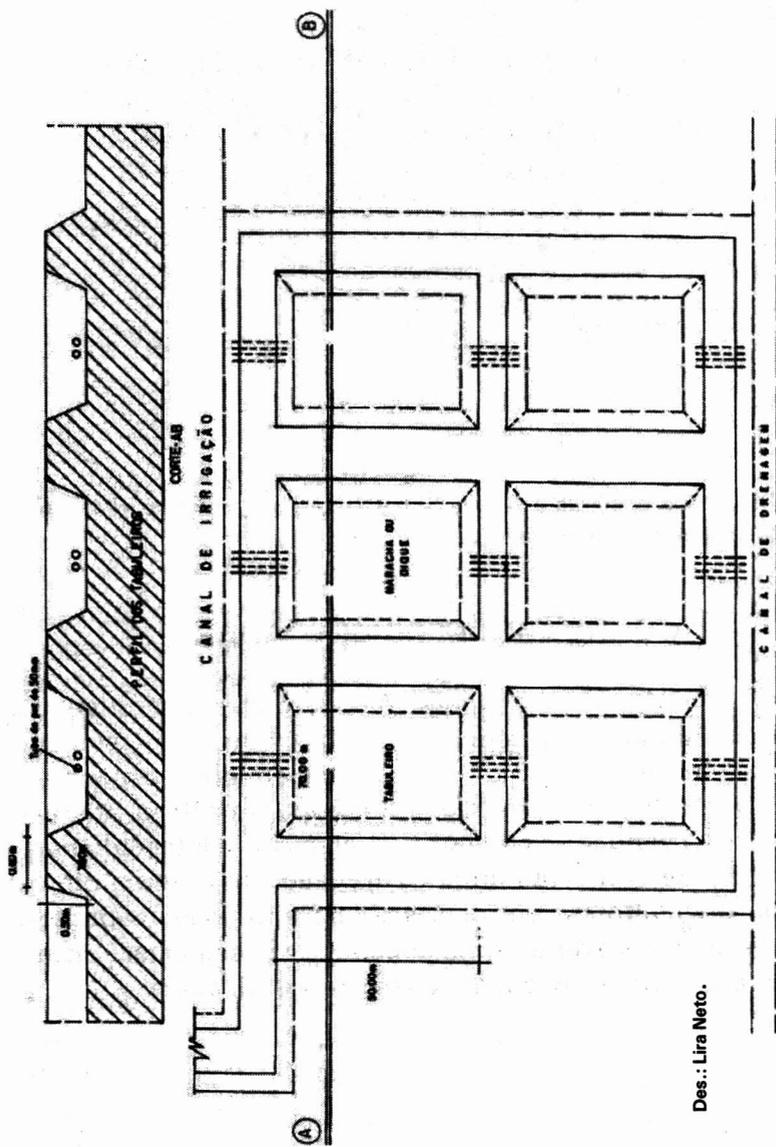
Planta baixa da localização da rede de irrigação e drenagem.
